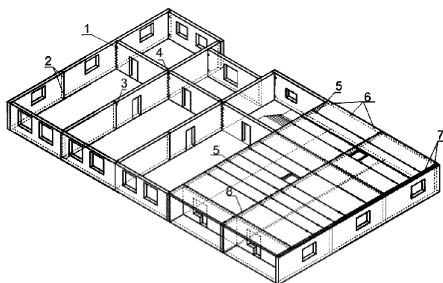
Схема расположения связей в крупнопанельном здании: 1 – между панелями наружных и внутренних стен; 2 – между панелями наружных несущих стен; 3 – между панелями поперечных внутренних стен; 4 – между панелями поперечных и продольных внутренних стен; 5 – между плитами перекрытий по их продольным сторонам; 6 – между плитой перекрытия и примыкающей наружной стеной вдоль длины здания; 7, 8 – то же, поперек длины здания.
